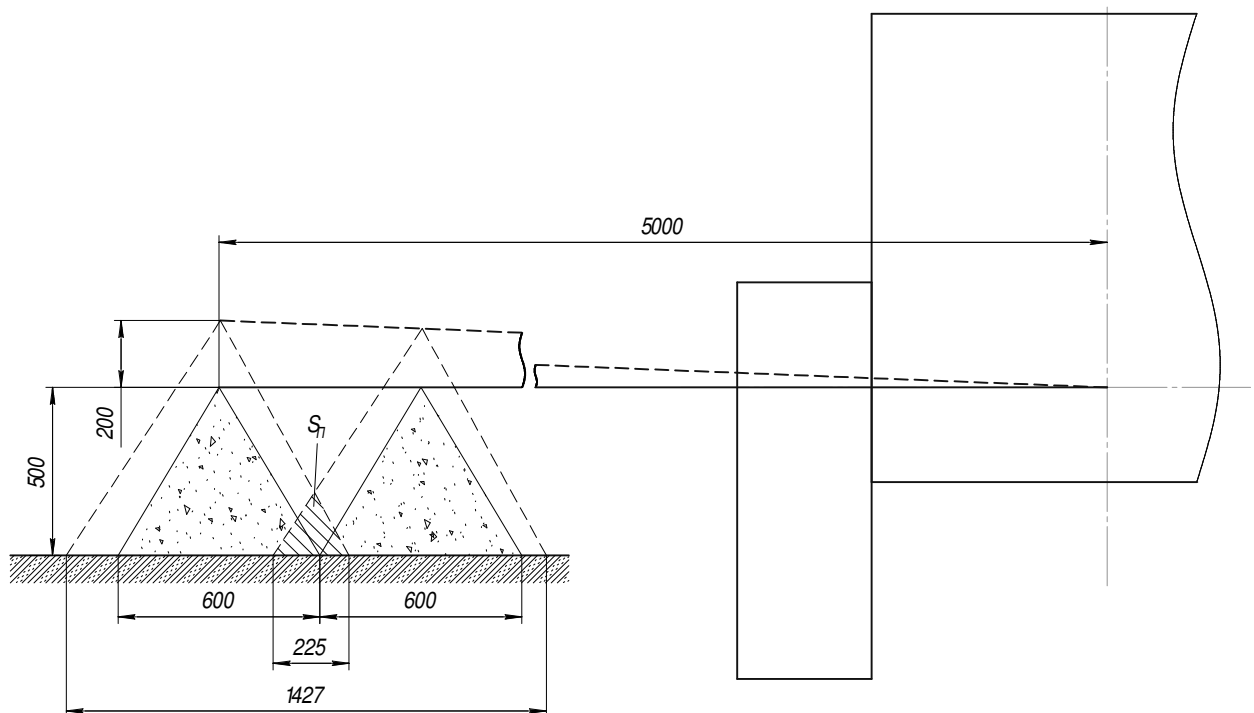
Розрахункова схема для визначення довжини штанги машини
